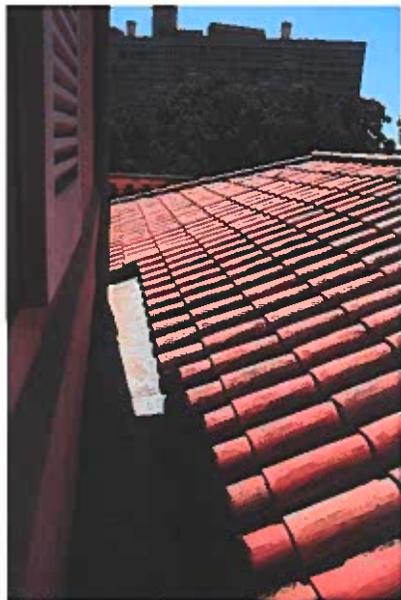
Vue générale de la couverture tuiles, bon état général, photo SASU Atelier Cord
